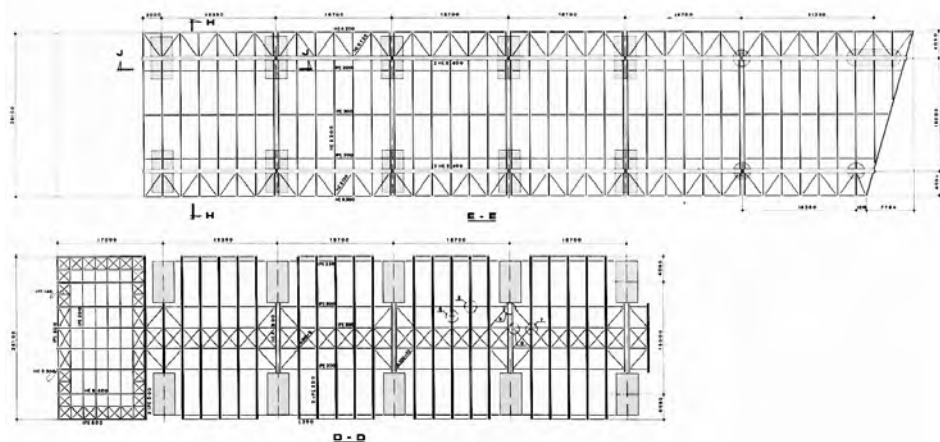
E-E) pianta a quota 23.025 m, D-D) pianta a quota 4.99 m
